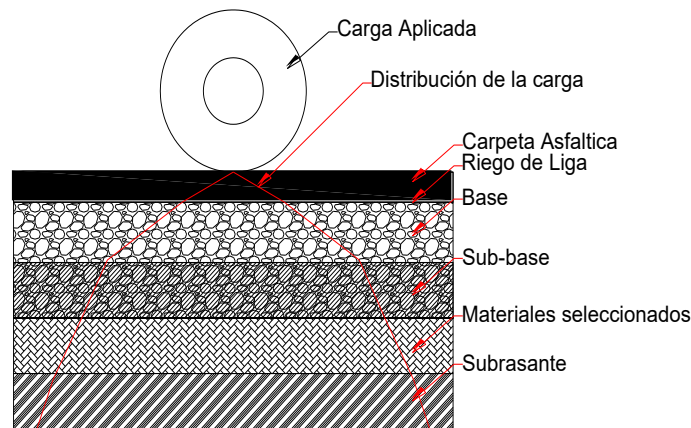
Diagrama de la estructura de un pavimento flexible y la distribución de carga (Adlinge & Gupta, 2013)
